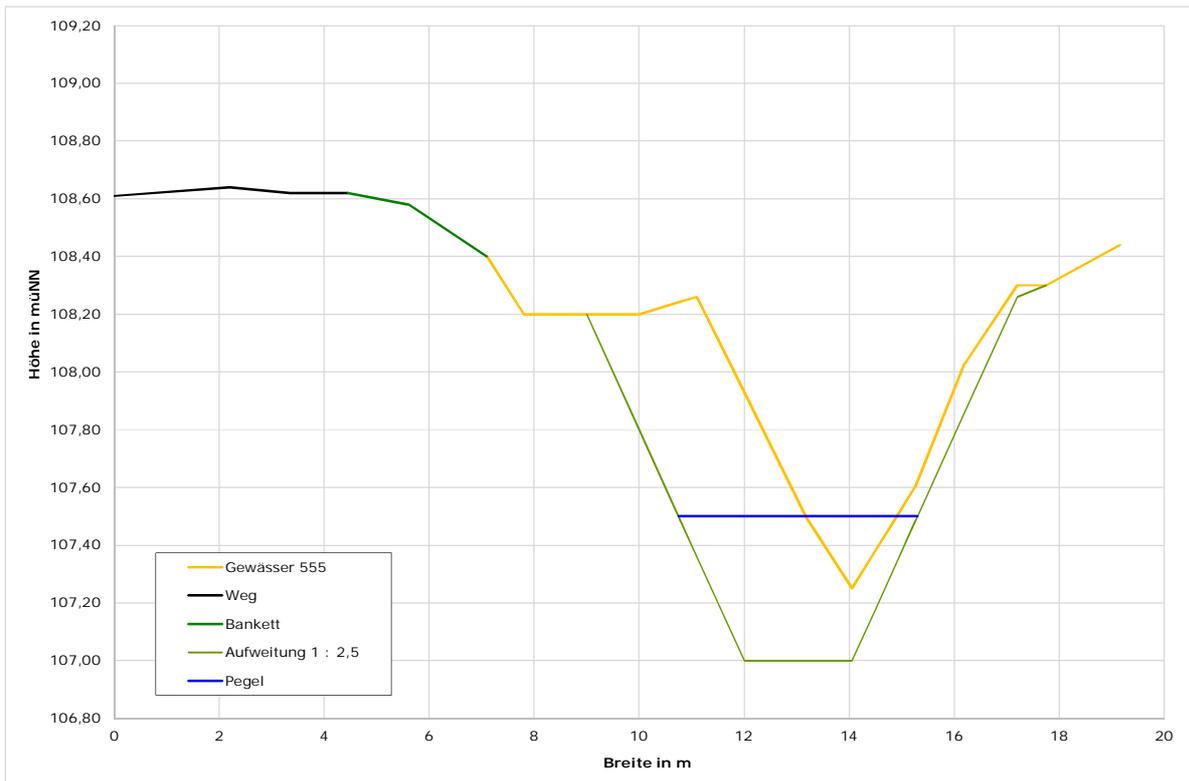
Querschnitt heute und künftig zur Rückhaltung im Gewässer
